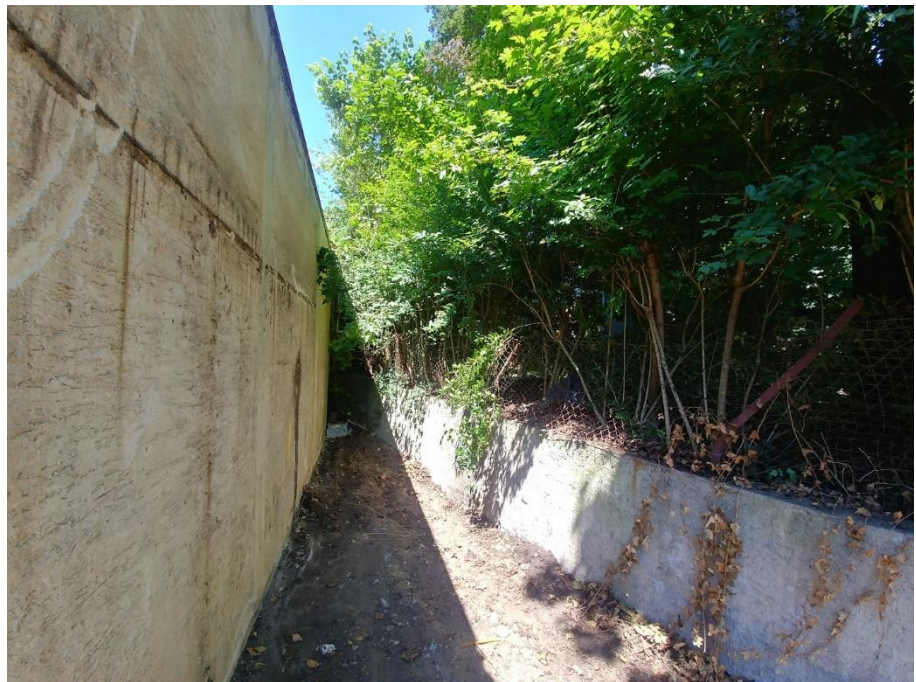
Walnussbaum westlich knapp außerhalb des Plangebiets, der erhalten werden kann.
